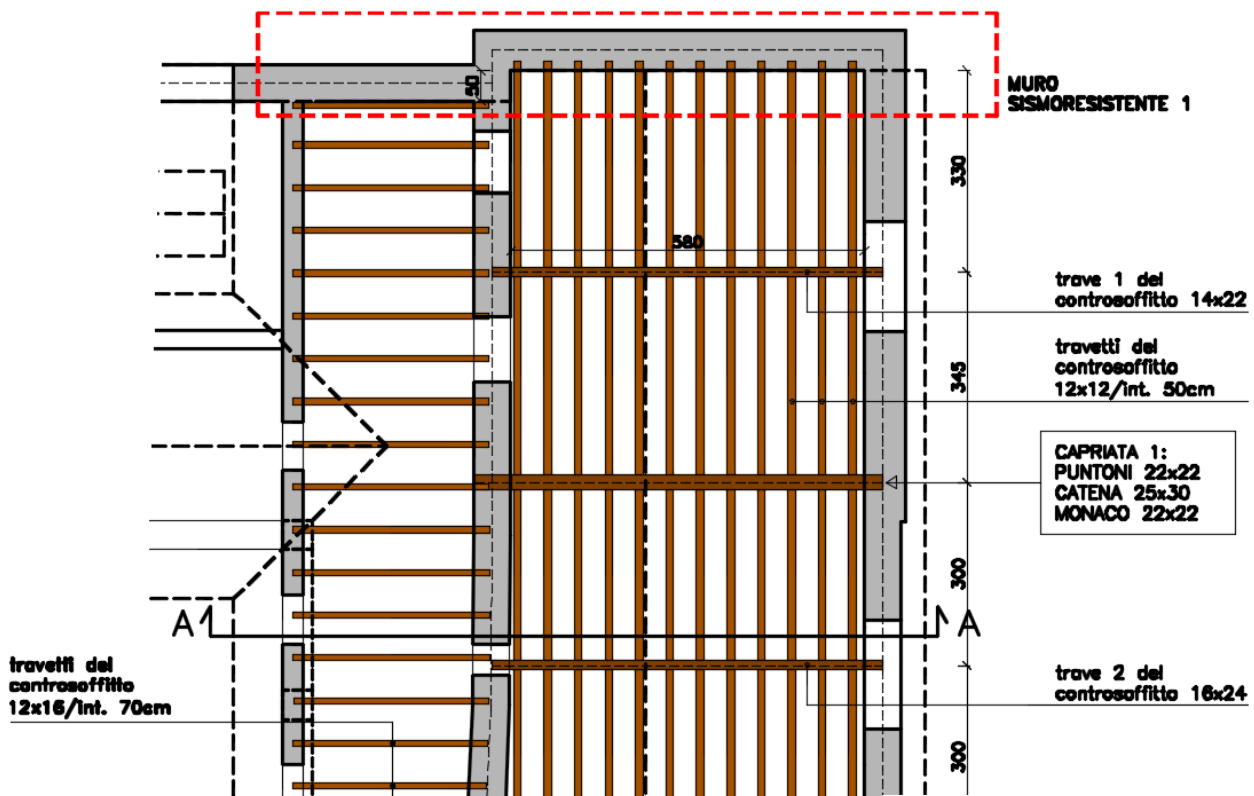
Pianta strutturale di porzione significativa della zona A degli elementi del solaio di sottotetto per individuazione degli elementi sottoposti a verifica
